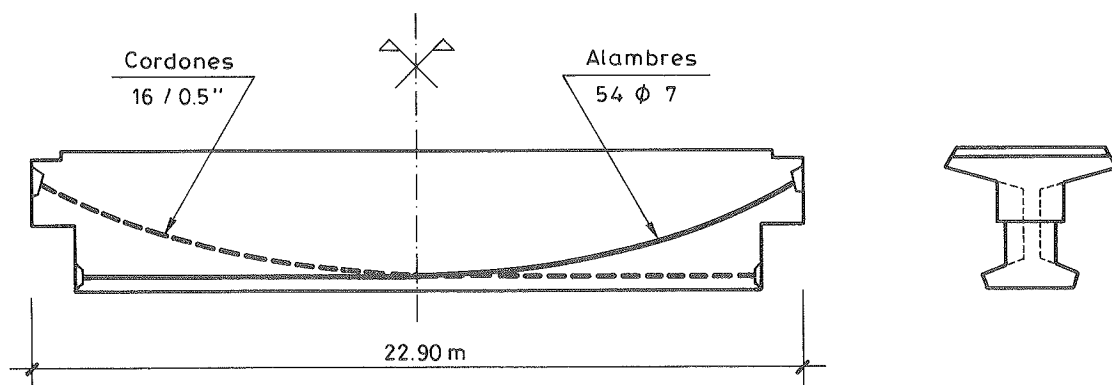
Características del trazado de la armadura activa en la viga ensayada.
